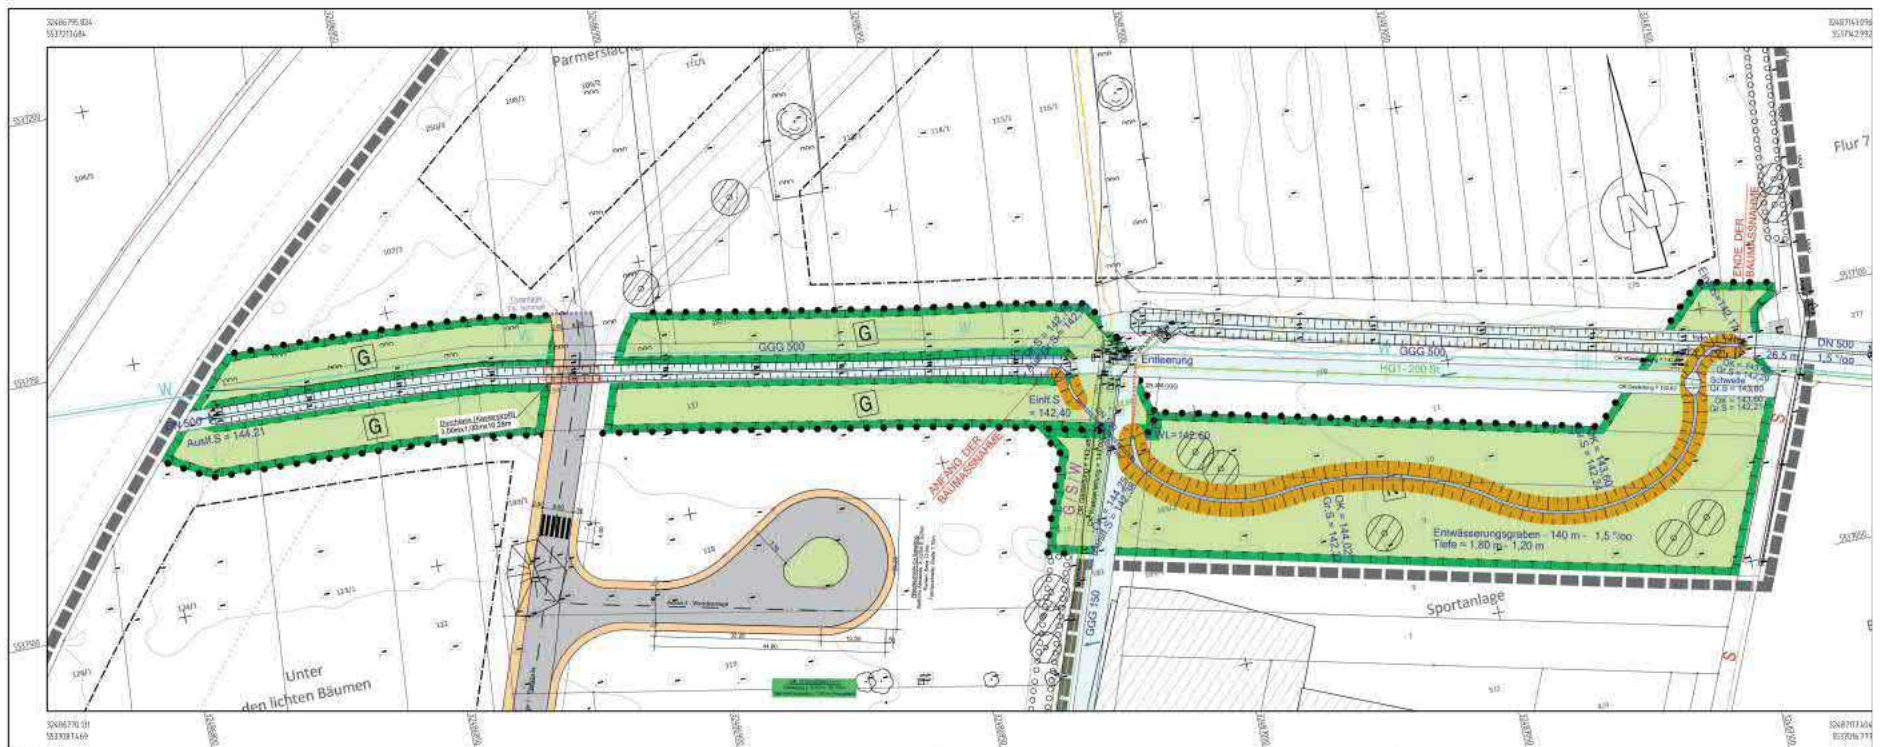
Lageplan Grabenverlegung, Stand: 10/2022
